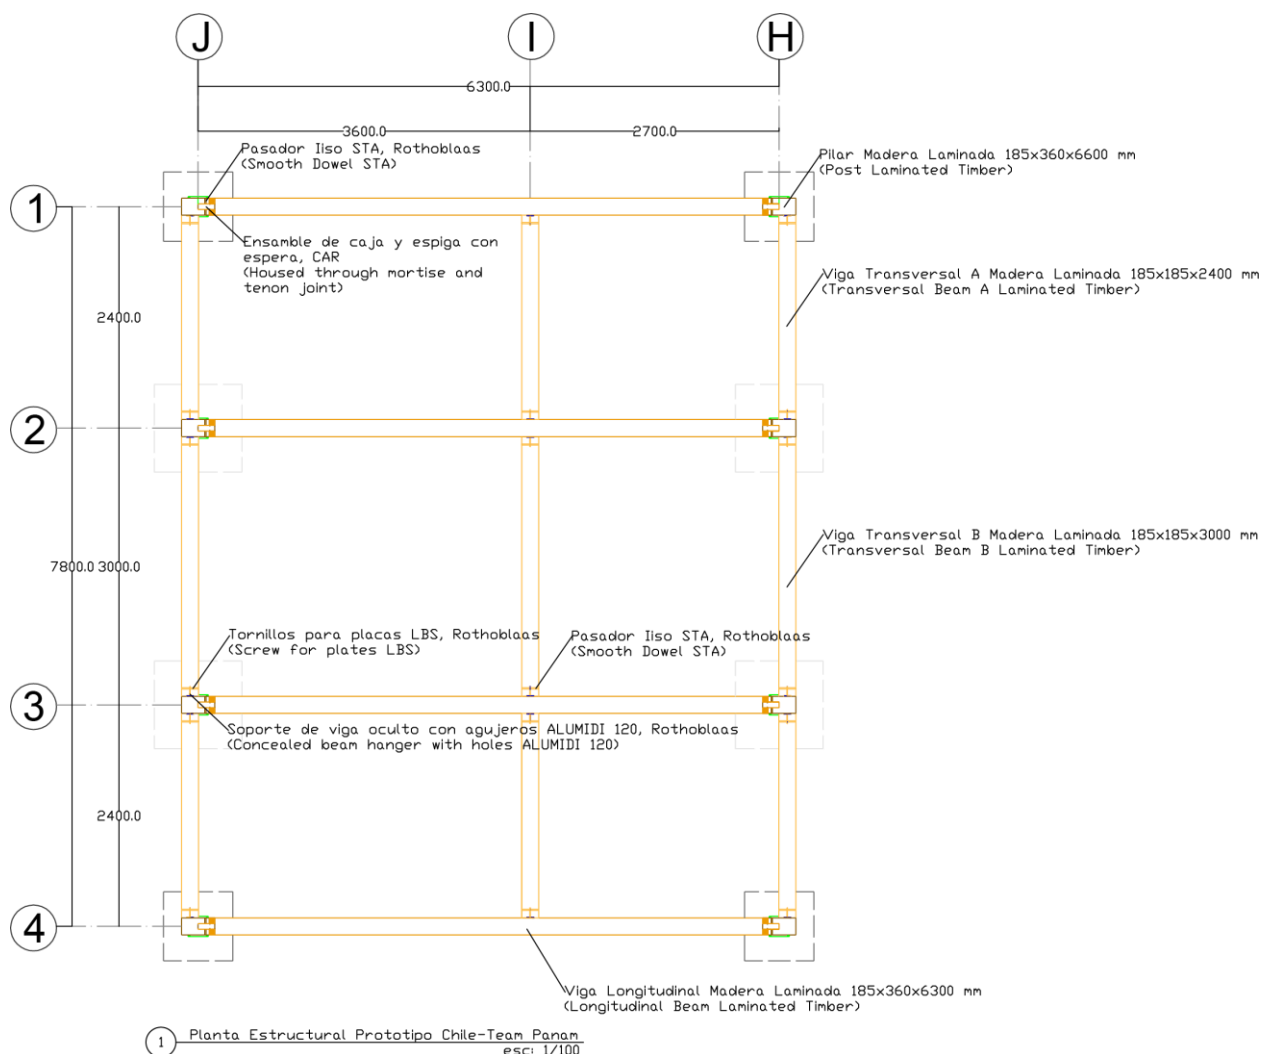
Planta estructural con detalle de ubicación de detalles técnicos. Elaboración propia.
